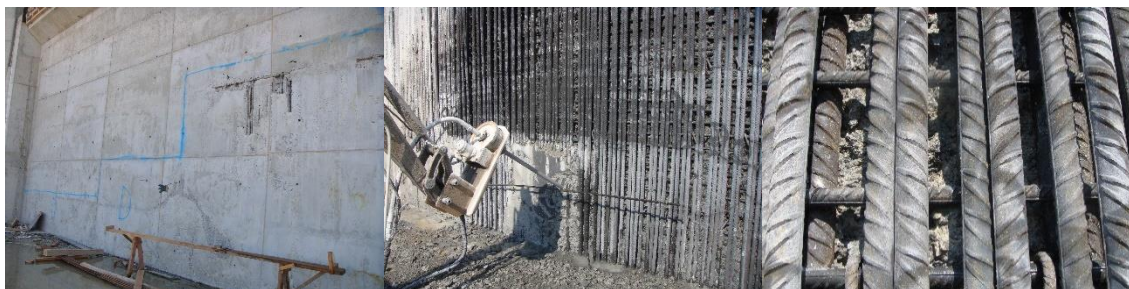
Reparación de coqueas internas en muro, mediante lanza adaptada a brazo hidráulico de excavadora (a) y (b). detalle de armado (c).
